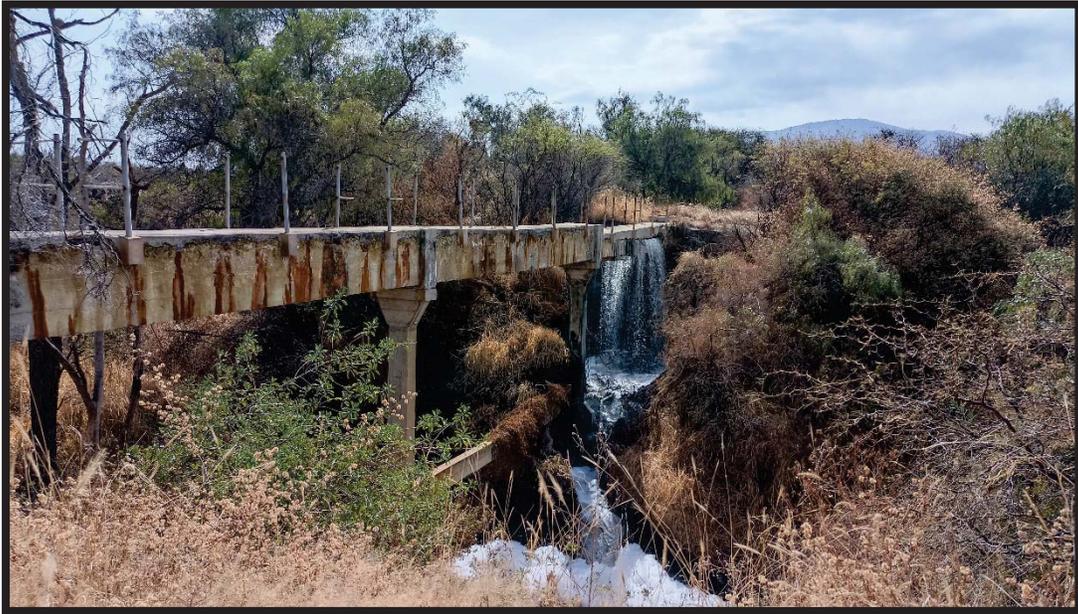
Puente Canal que une la Segunda Laguna facultativa con Laguna de Maduración Rotura Longitudinal Colapso Parte Superior
